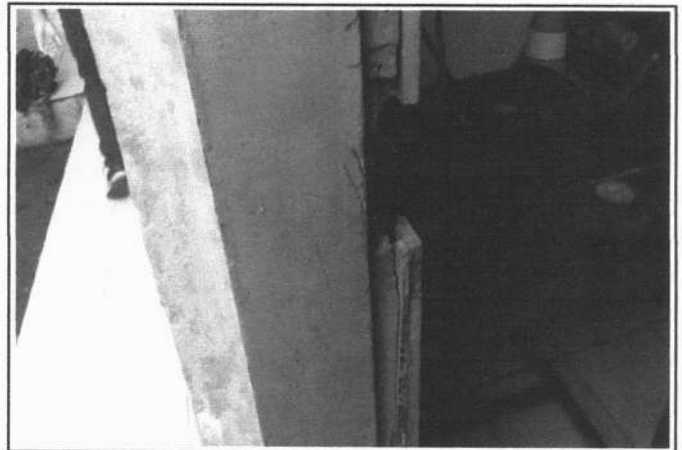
SUBSTITUIÇÃO DE FORRAMENTOS
